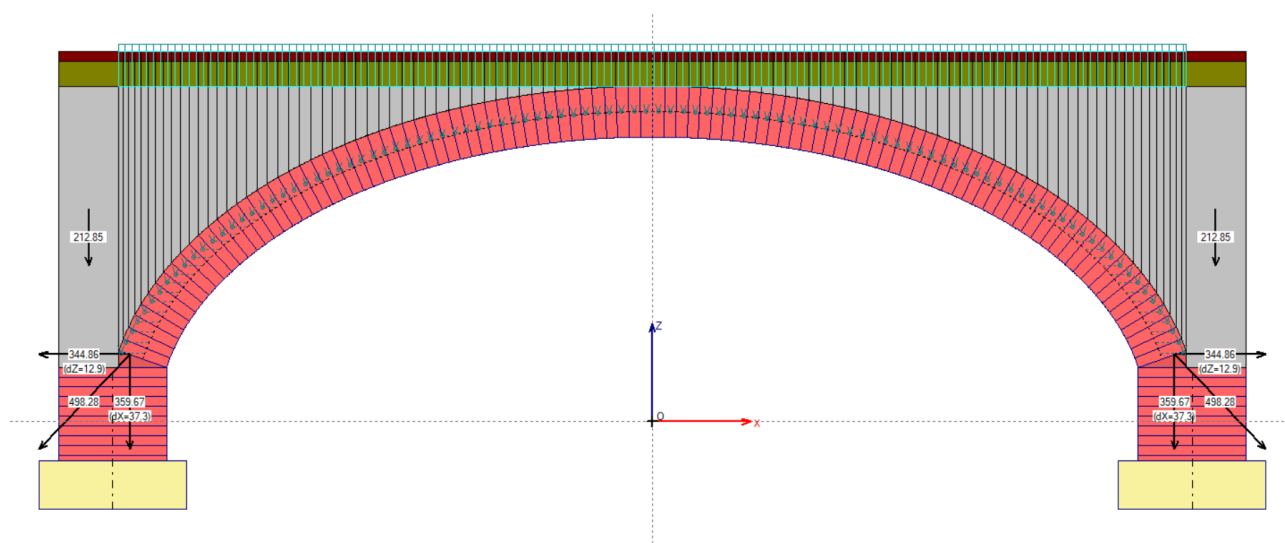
Azioni alle imposte: sottotondo, pavimentazione e carico distribuito q_{1k}
